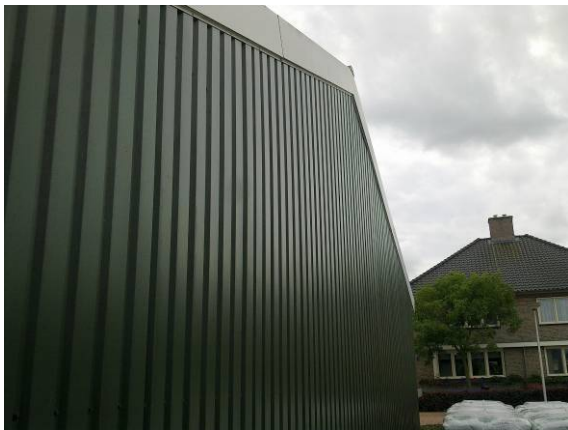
Zijwand van de loods van golfplaat; er zit ook geen ruimte tussen wand en daklijst
